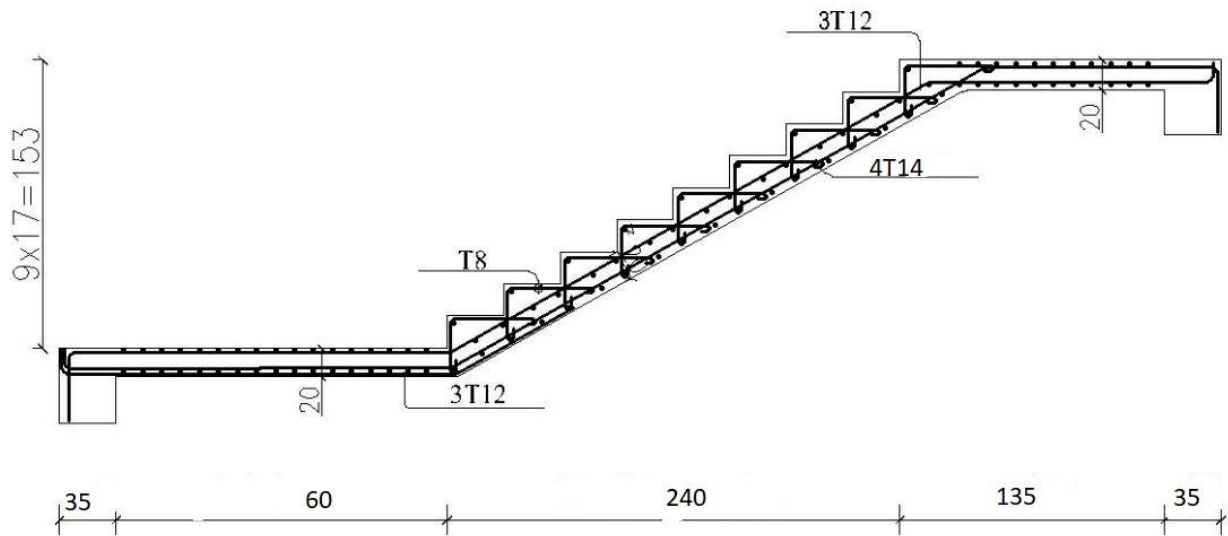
Schéma du Ferrailage des escaliers (vue en élévation)
